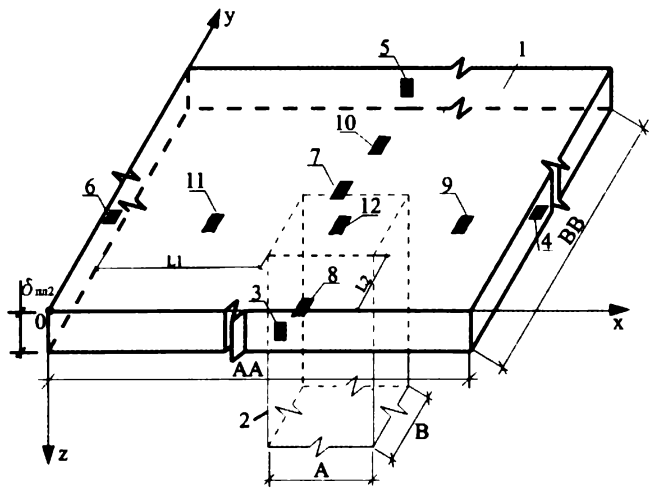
Расчетная схема фрагмента бетонированной плиты перекрытия, сопрягаемой с ранее забетонированной колонной
